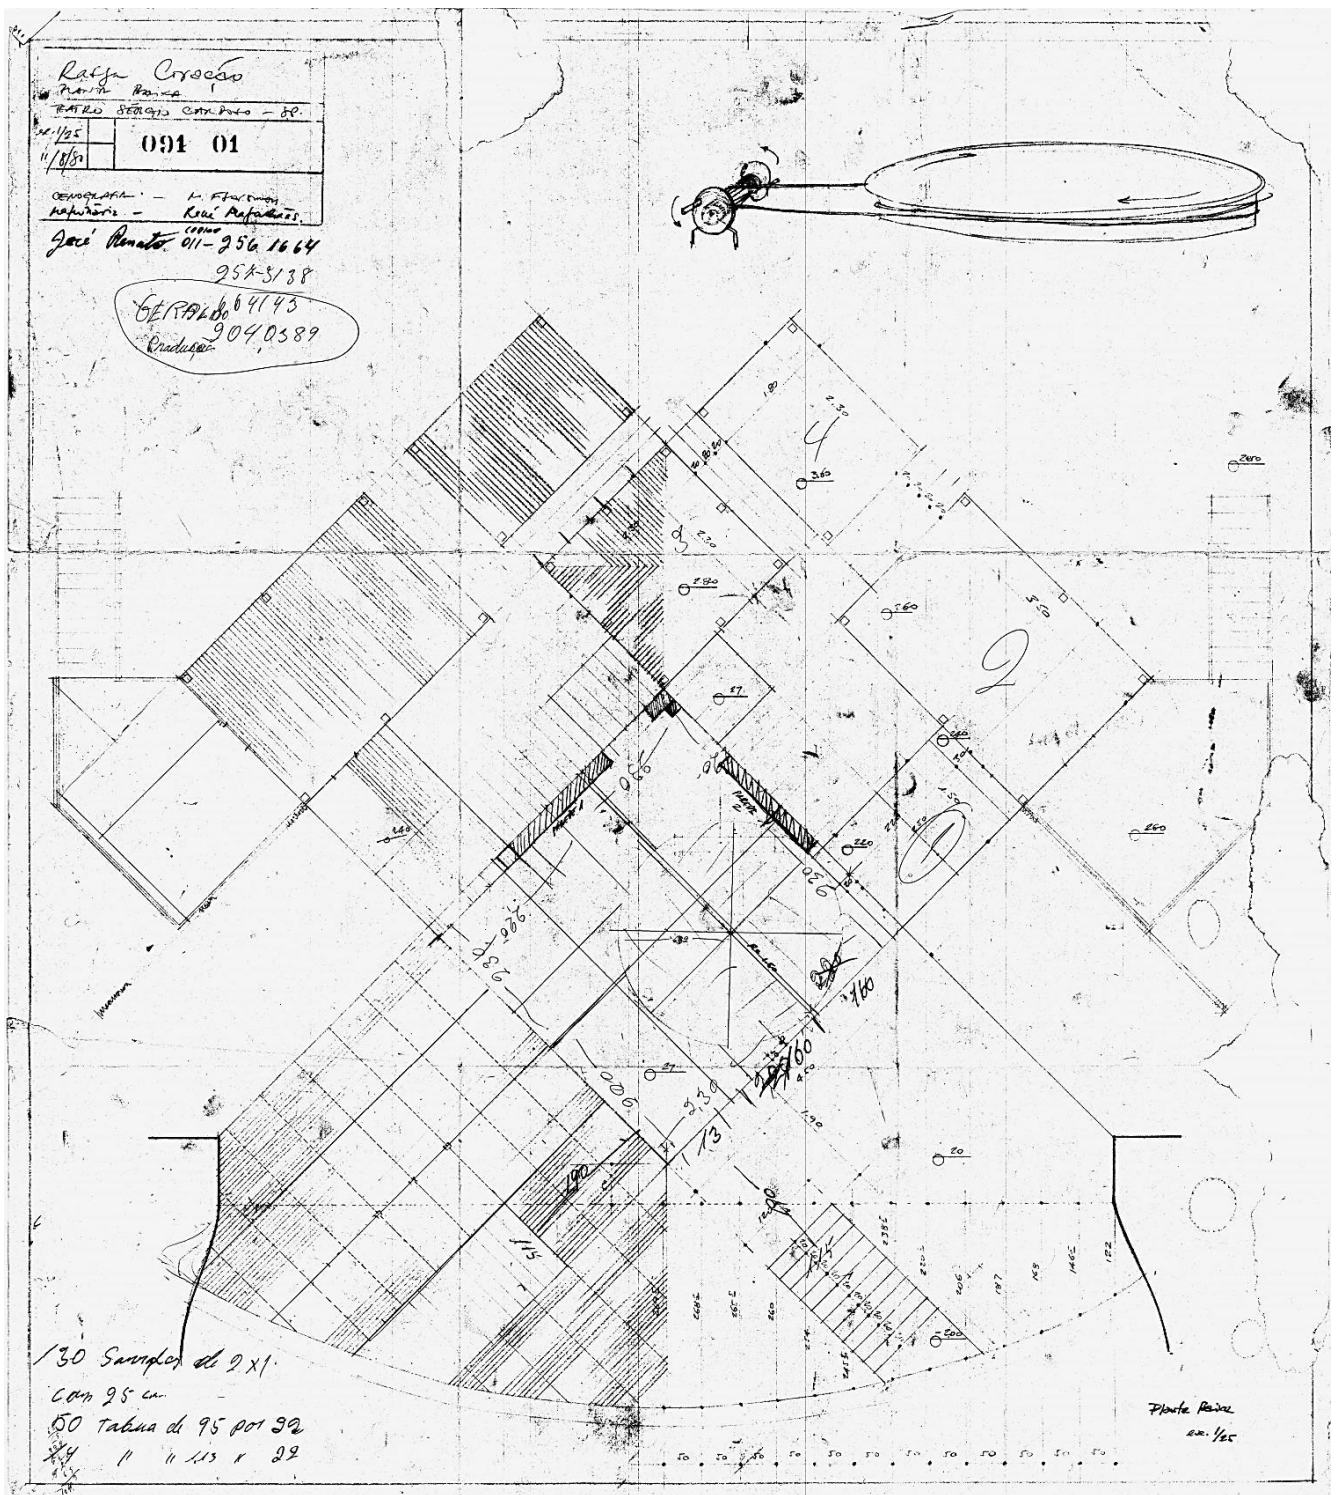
Planta original de *Rasga Coração* (1980). Teatro Sérgio Cardoso, SP.
